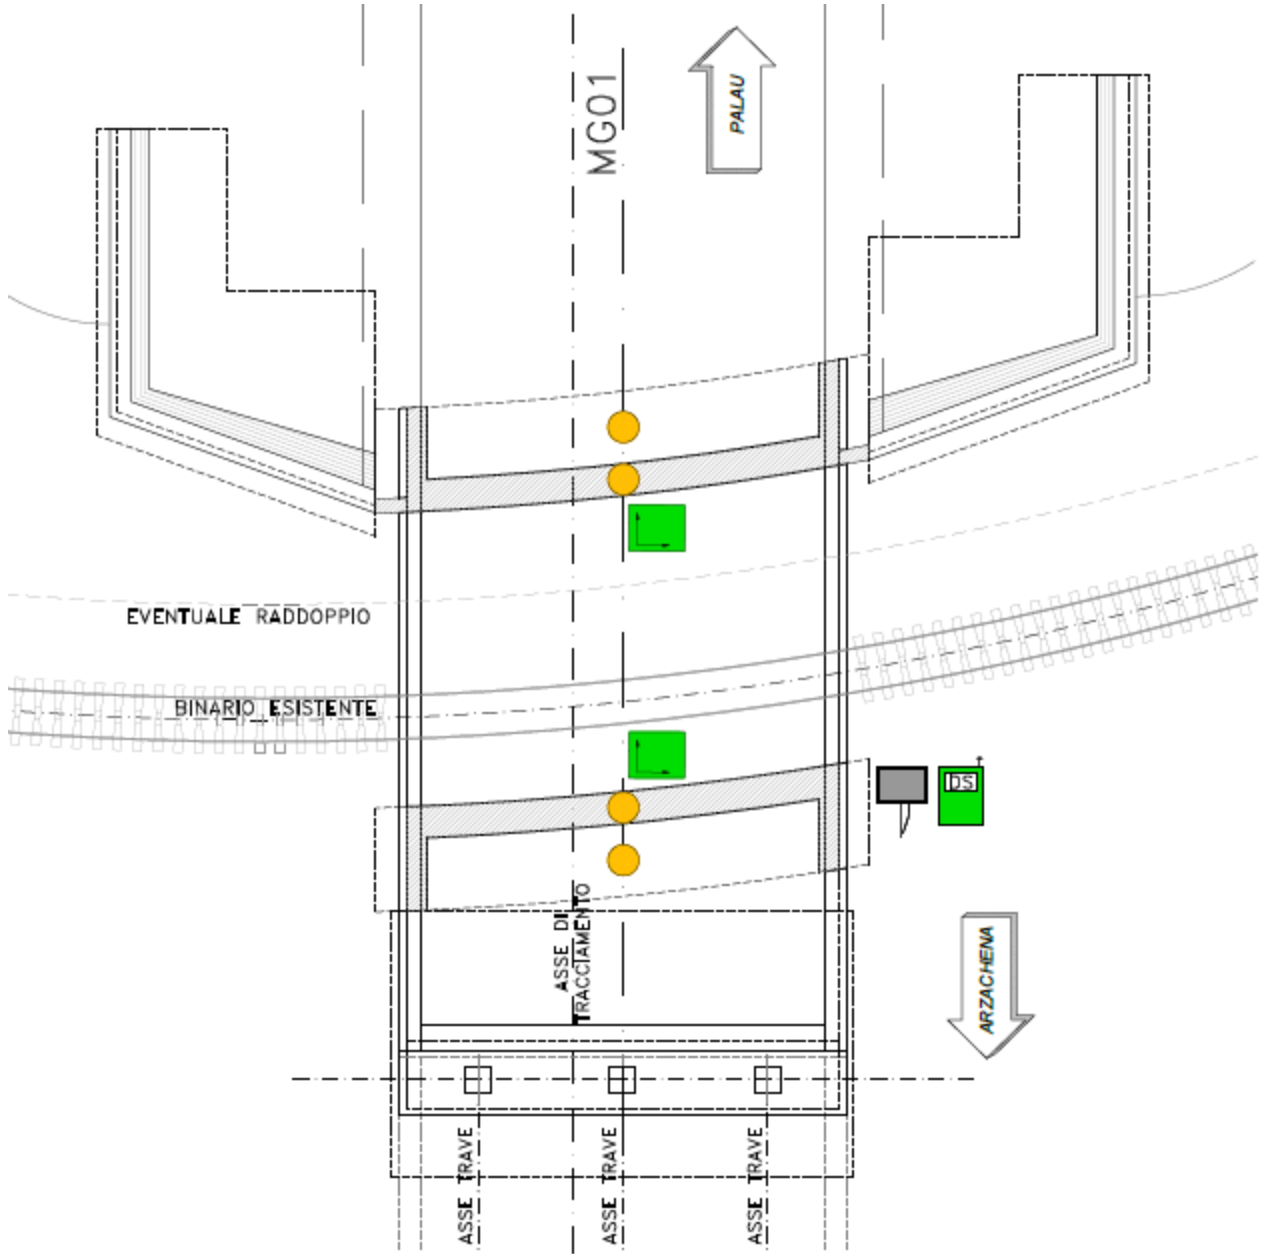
Schema posizionamento strumentazioni cavalcavia e cavalcaferrovia – Pianta
